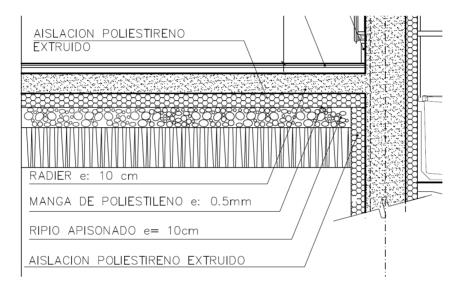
Detalle constructivo de radier Fiscalía Local Cañete.
